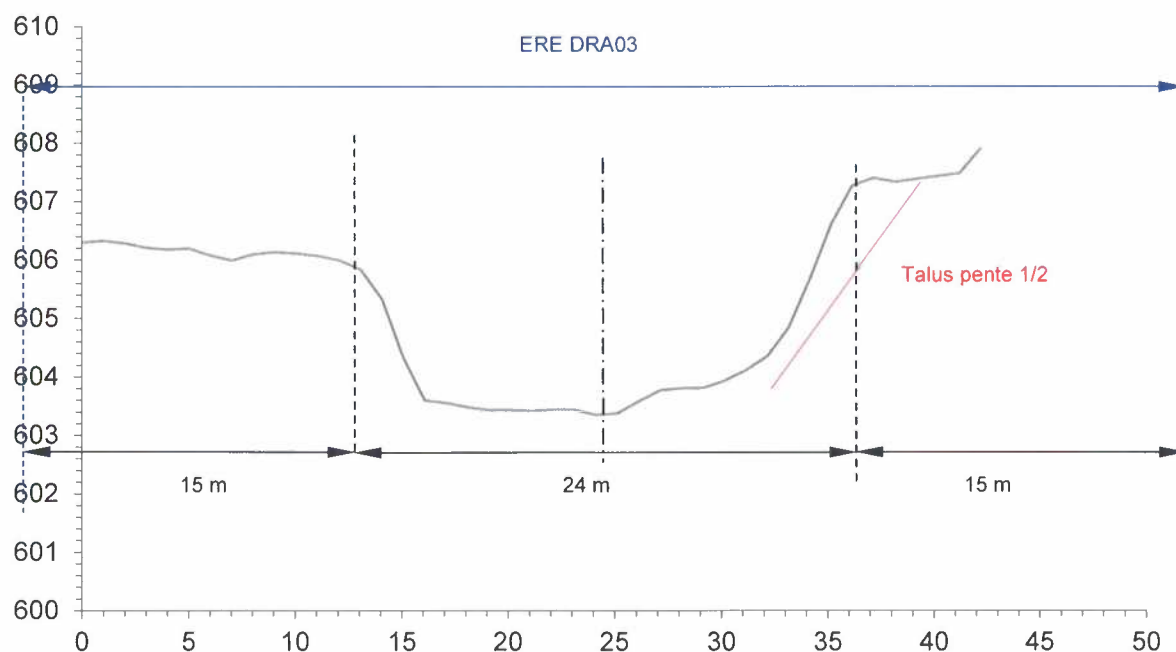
Profil en travers de la Dranse en aval du pont du cimetière
